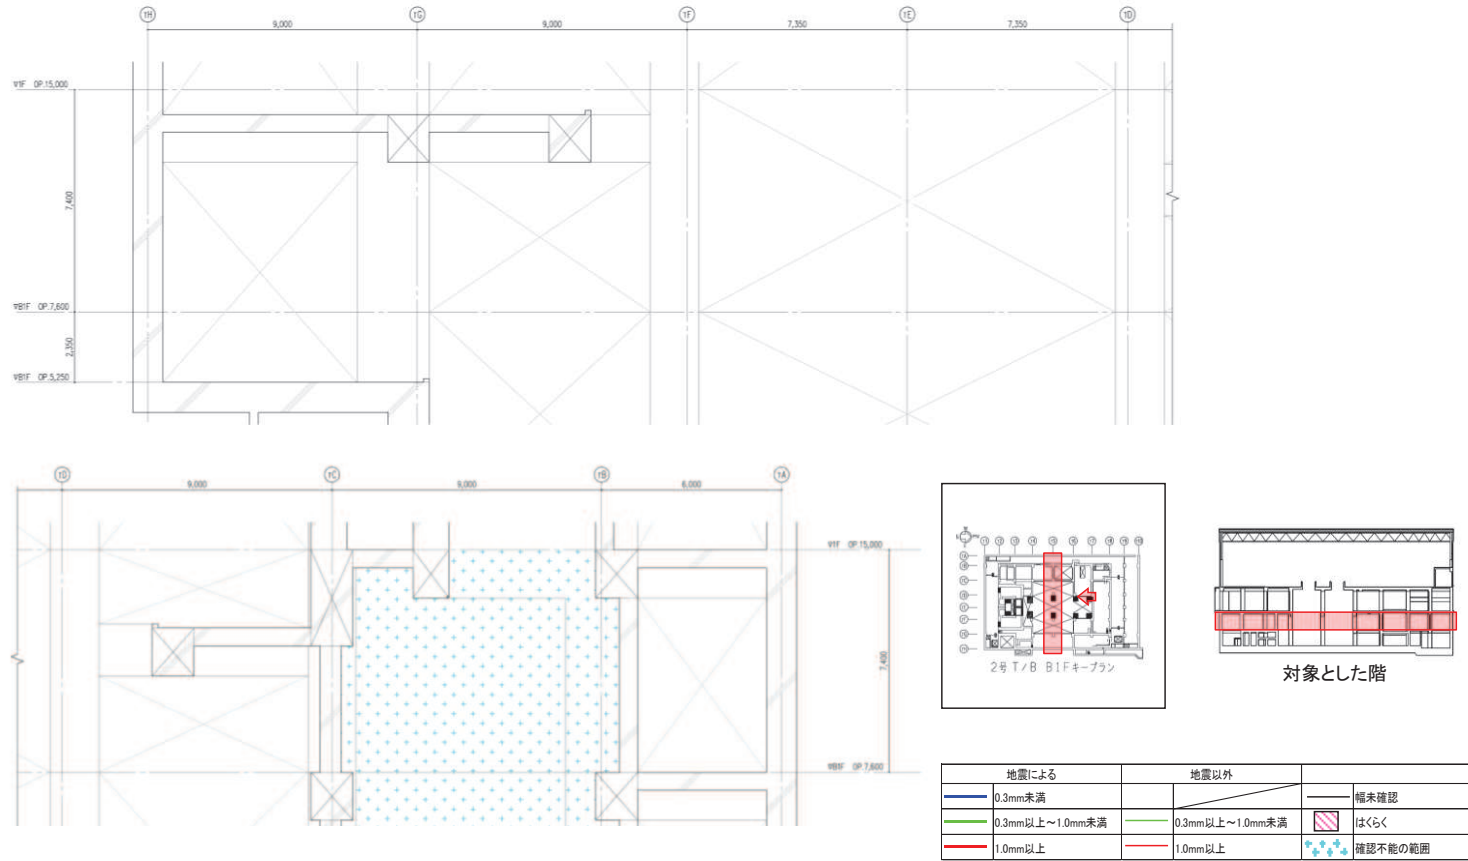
タービン建屋のひび割れ分布 耐震壁 (21) 地下 1 階 T5 通り
